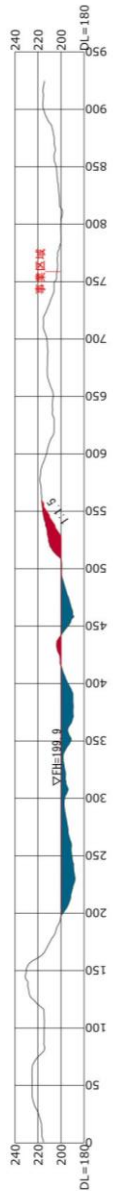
(2) 切土・盛土計画断面図 (E2-E2' 断面)
